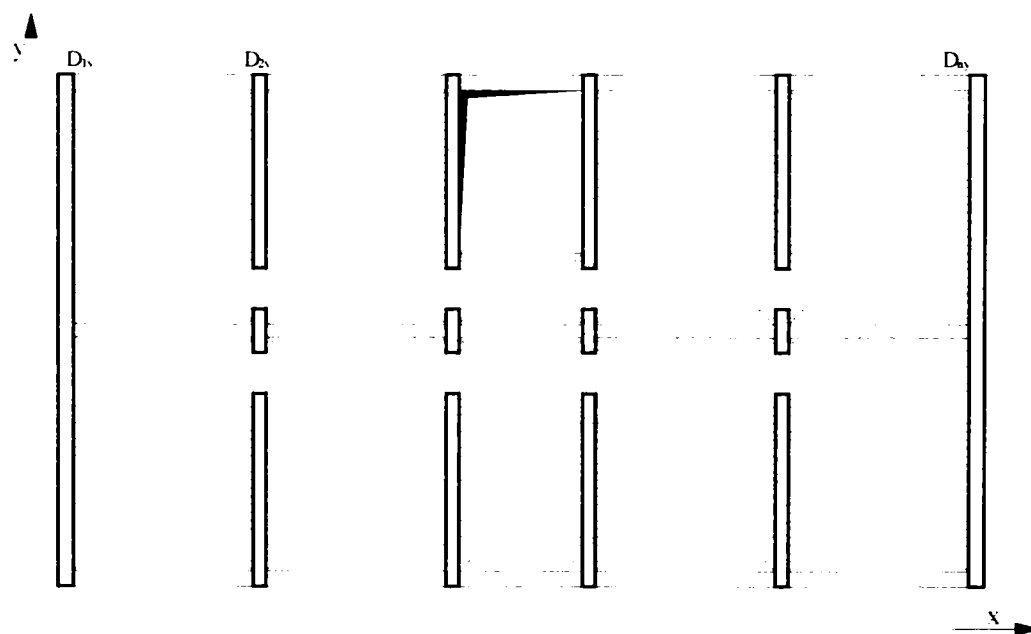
Schema diafragmelor și aria aferentă (zona hașurată) pe direcția y în cazul structurilor din zidărie cu planșee de beton armat monolit
